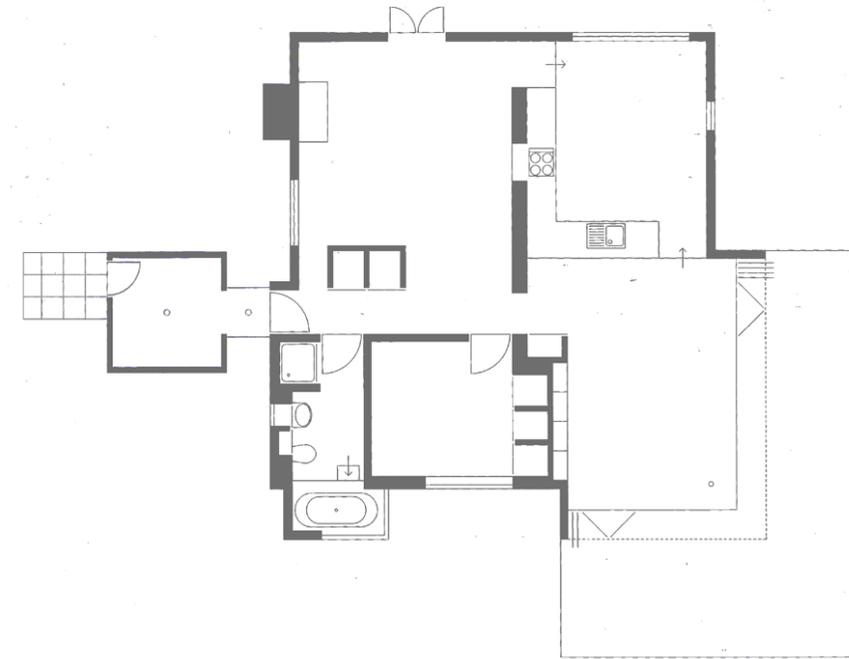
Gelon Hanna House - Planta arquitectónica. Elaboración: Shigeru Ban Architects
